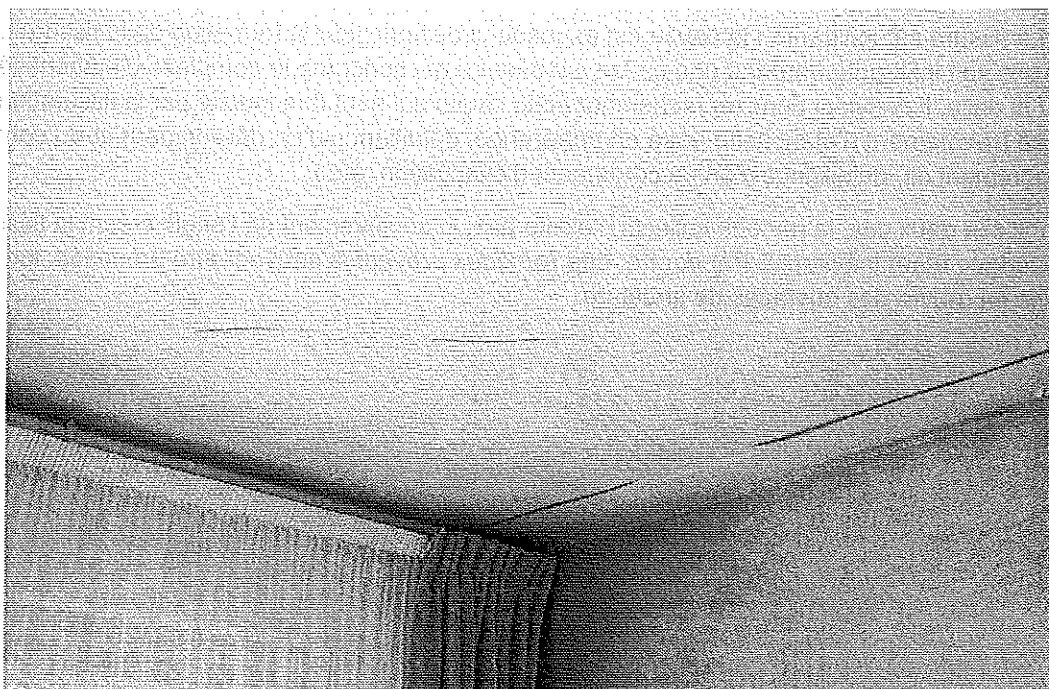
Fissure d'angle droit à 45° dans une dalle BA de l'avant-dernier étage d'un immeuble élevé (R + 15) ; fissure à caractère esthétique. © J. Putatti
